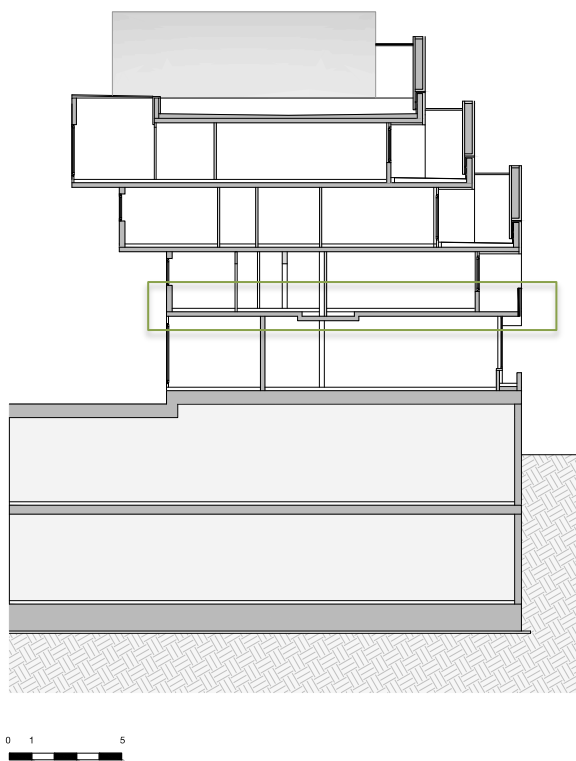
Schematischer Querschnitt durch das Stahlbetongebäude
